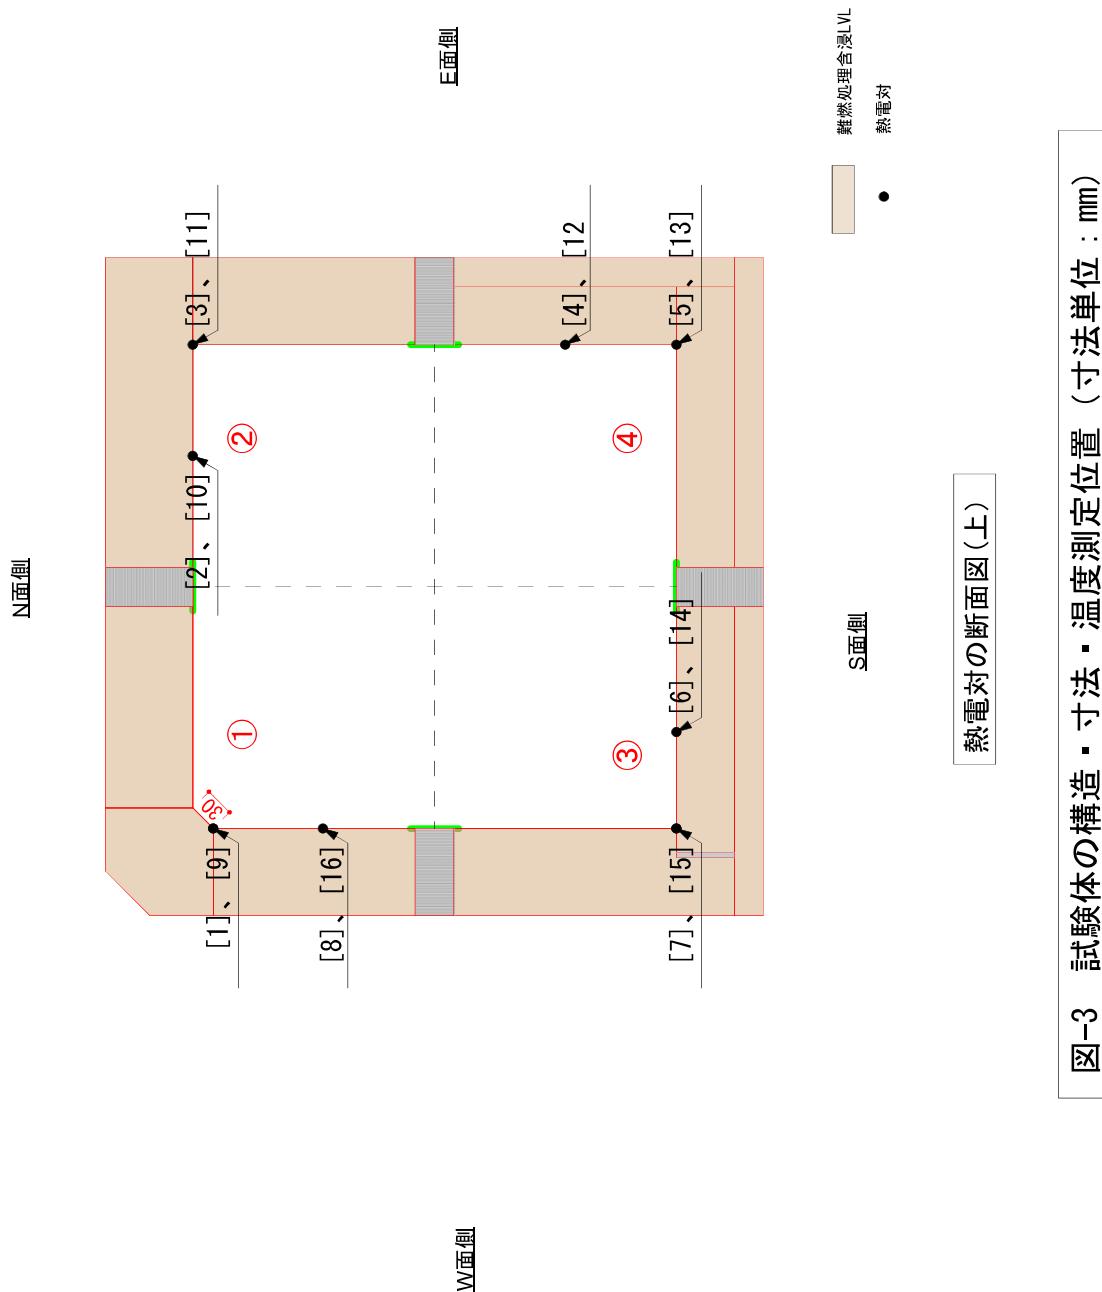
試験体の構造・寸法・温度測定位置 (寸法単位 : mm)
